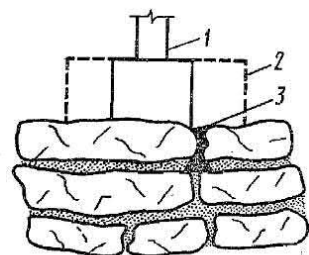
Фундаменты на крупноблочных элювиальных грунтах:
